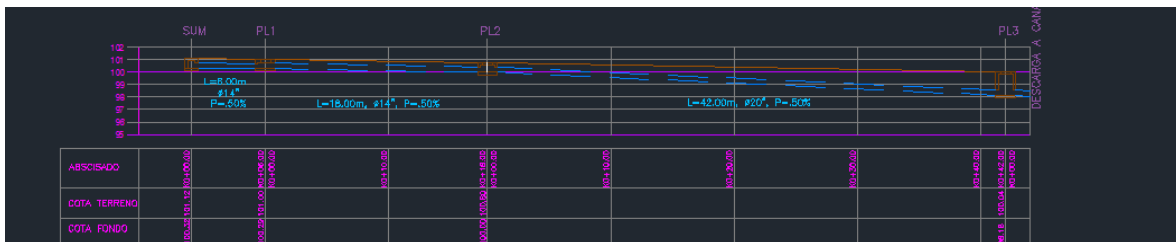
Captura plano Autocad vista perfil de los diseños constructivos. Barrio Floresta Baja
